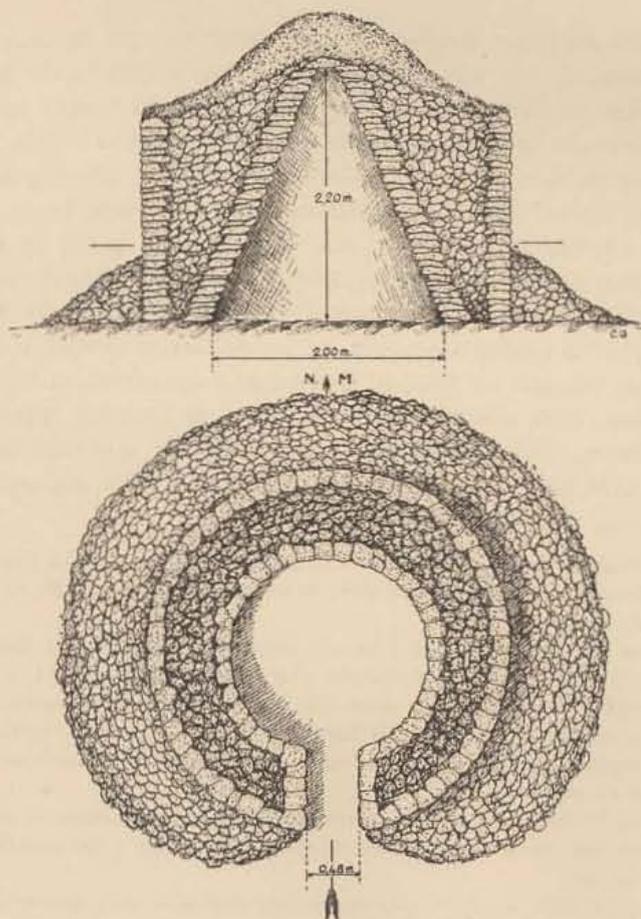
Fig. IV. Alzado y planta de un cacherulet moderno. Tipo valenciano.
